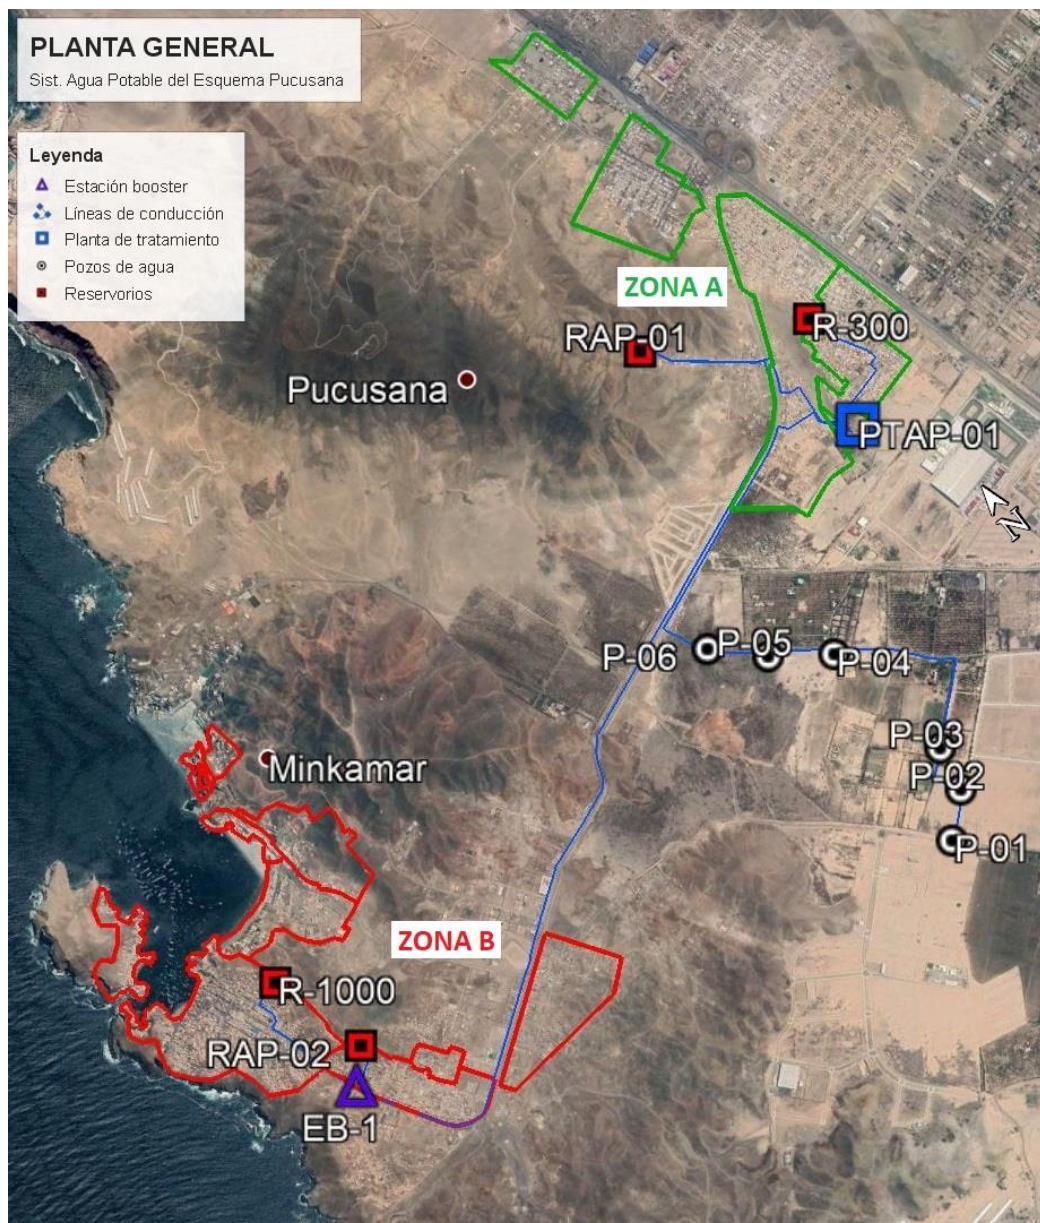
Planta general del proyecto. Fuente: (Consortio Saneamiento Lima Sur, 2016)
